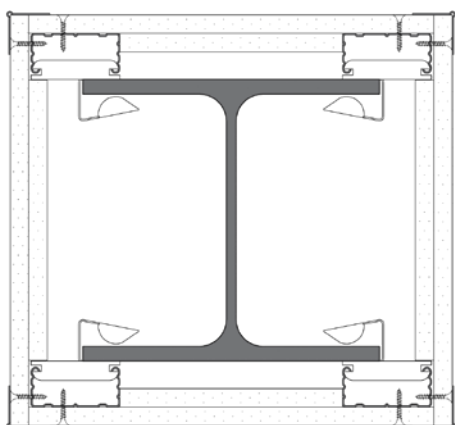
Protection poteau simple peau avec bandes de plâtre
